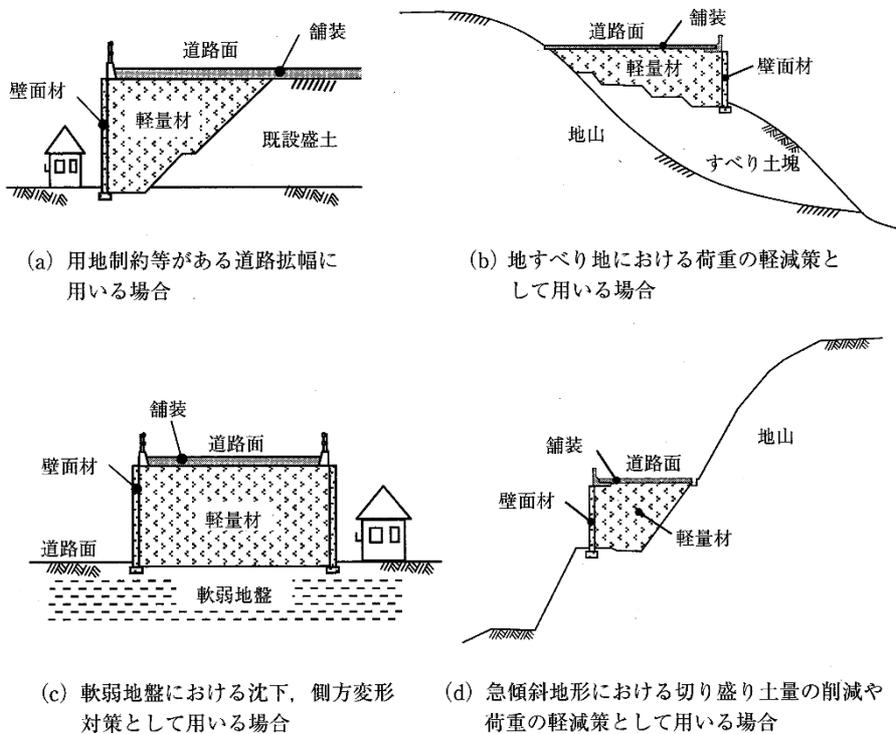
軽量材用いた擁壁の適用例⁸⁾
